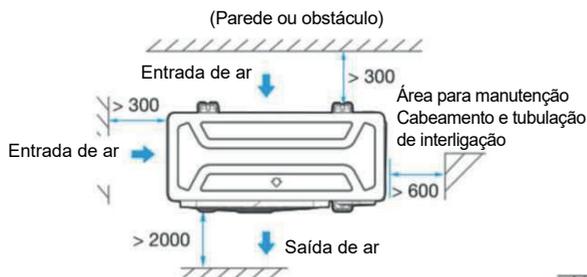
Vista lateral da instalação de somente uma unidade central (dimensões: mm)
